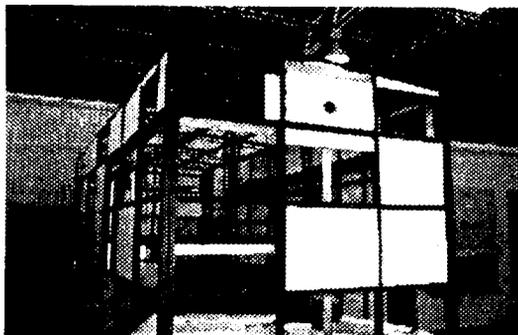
Shelter Estructural con equipos de aire acondicionado
